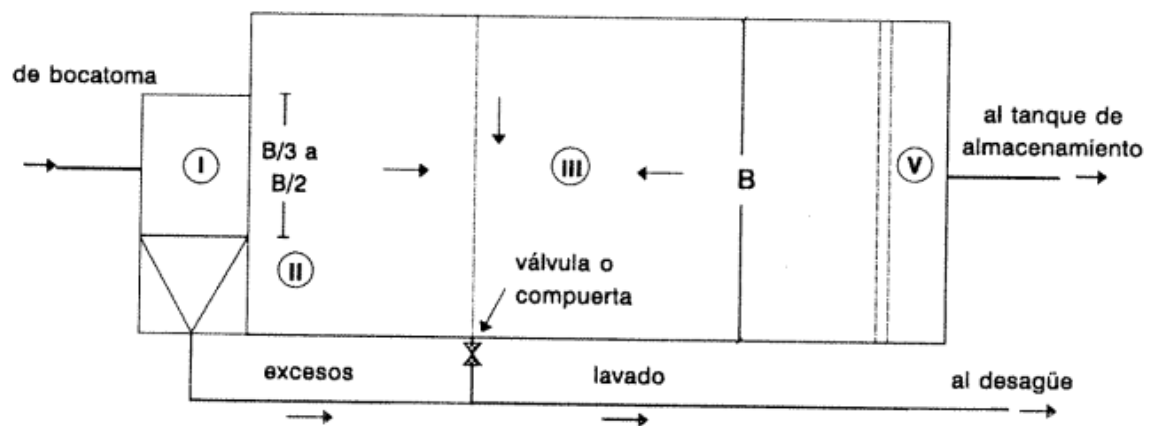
Planta del desarenador. Fuente: (Cualla, 2000)
